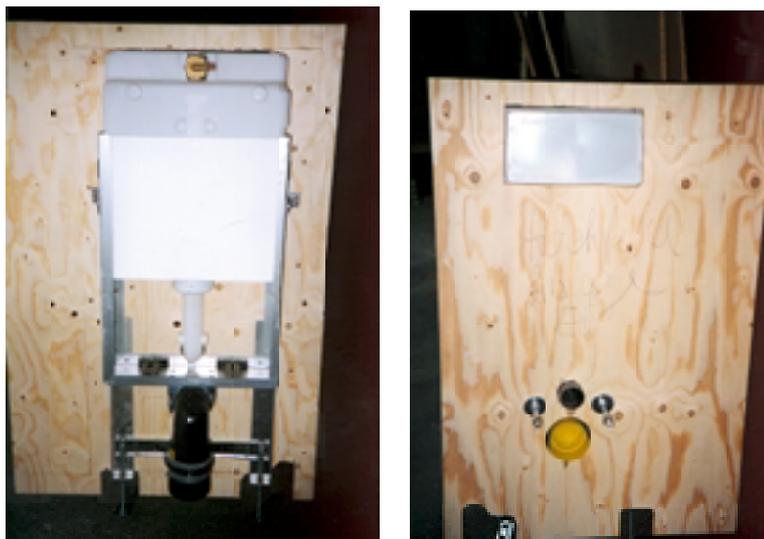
Vorwandinstallationen werden als Installationselement vorgefertigt und als Element in die entsprechende Wand eingebaut.
